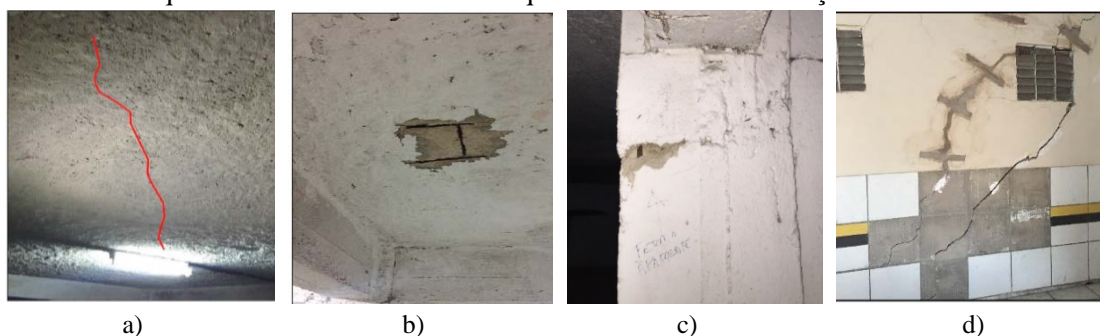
Manifestações patológicas nos elementos analisados. a) Possível fissura de flexão em laje; b) Destacamento do concreto de cobrimento da laje; c) Manifestações patológicas nos pilares; d) Fissuras em alvenaria de vedação.
